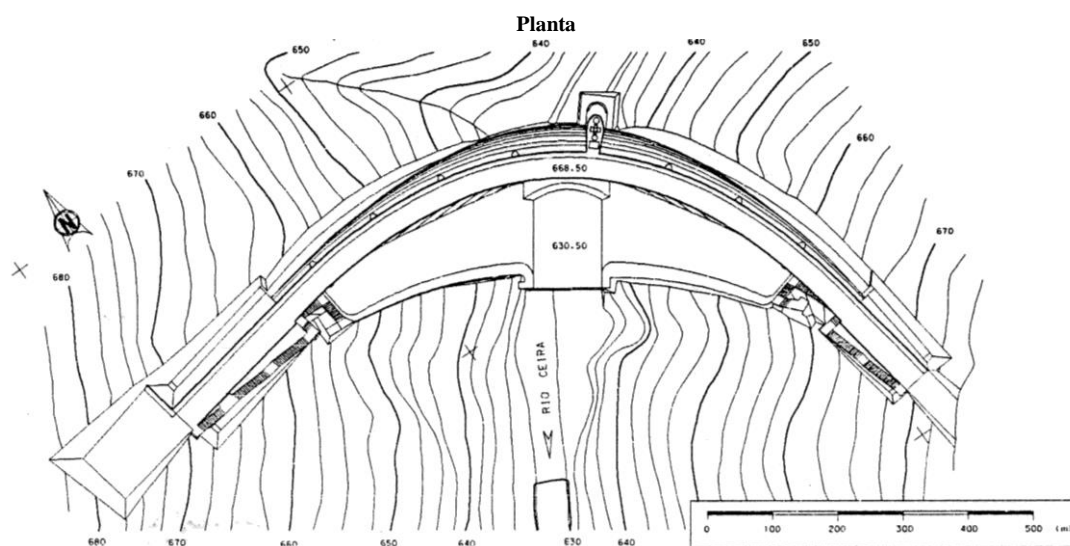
Planta geral da barragem de Alto Ceira II.
